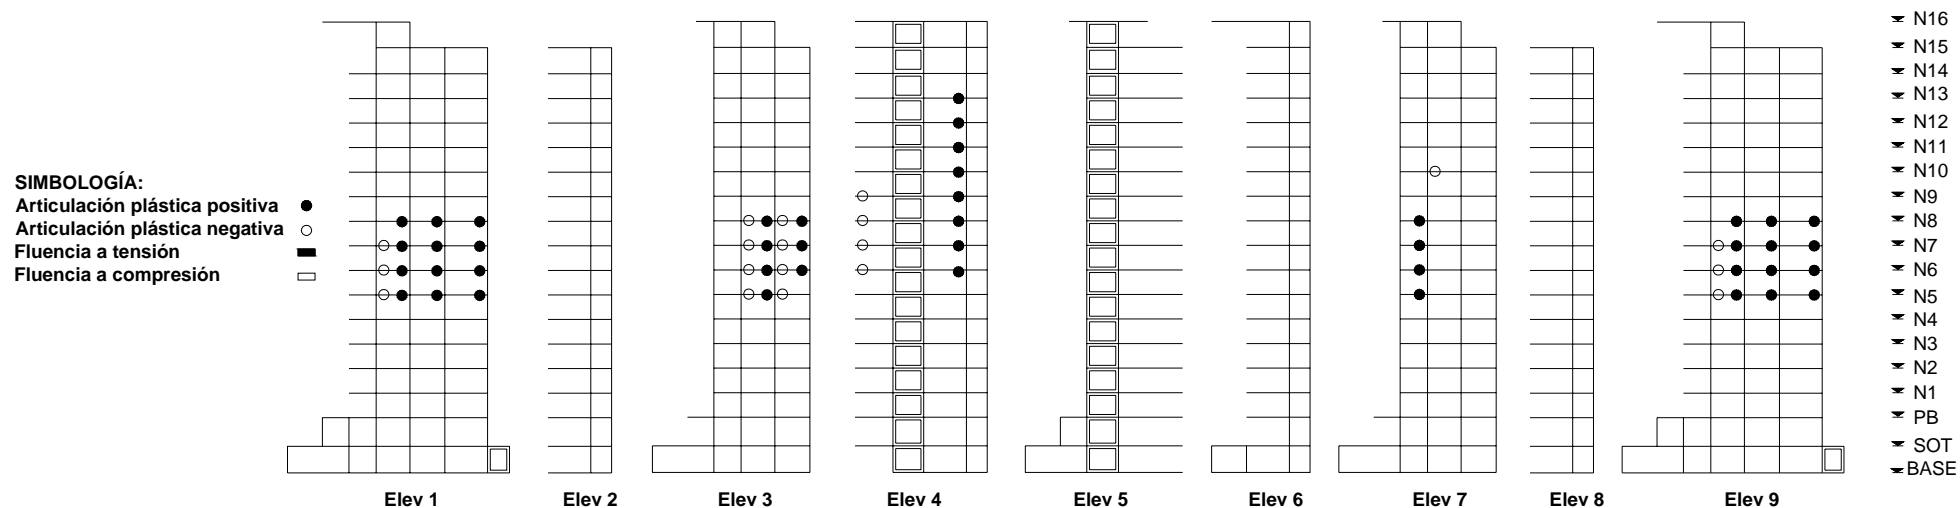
Formación de articulaciones plásticas en vigas y columnas para la SIM81 a los 61.90 s
